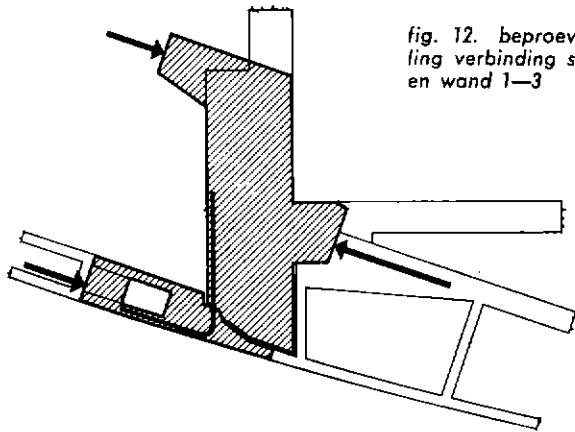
beproevingsopstelling verbinding schoor 0-3 en wand 1-3
